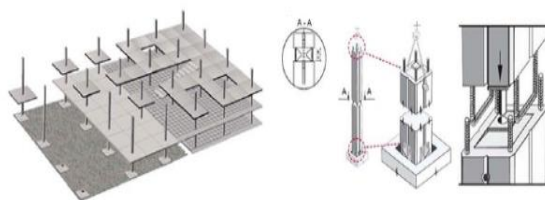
Схема расположения элементов и схема соединения колонн системы КУБ 2.5
